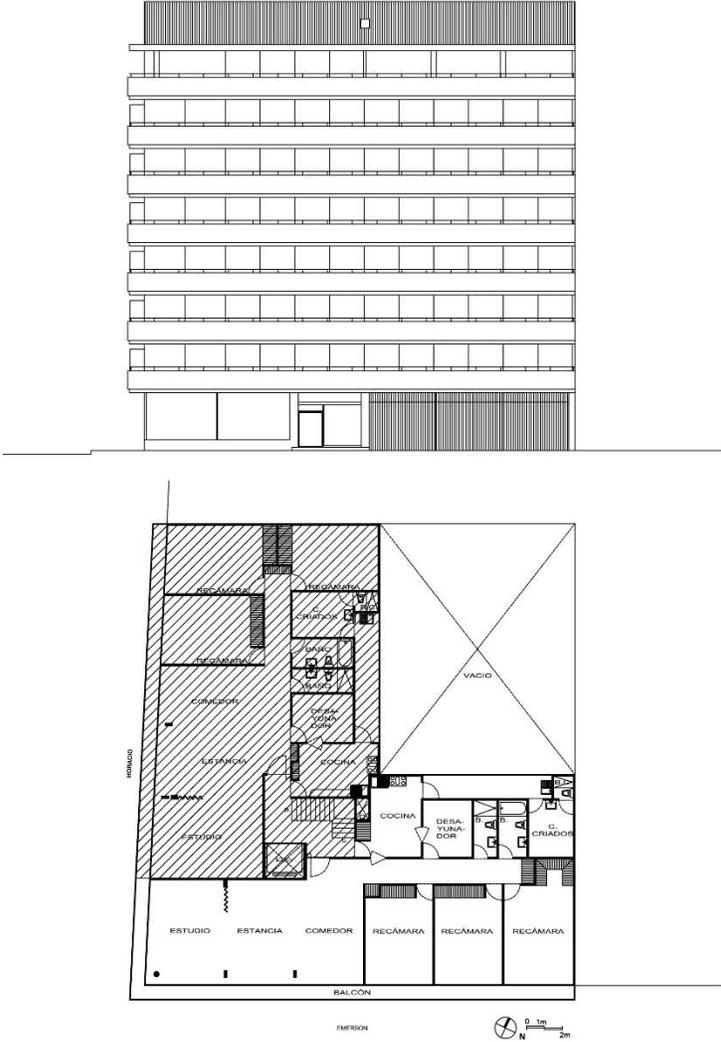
Fachada y planta del edificio ubicado en Emerson núm. 251
